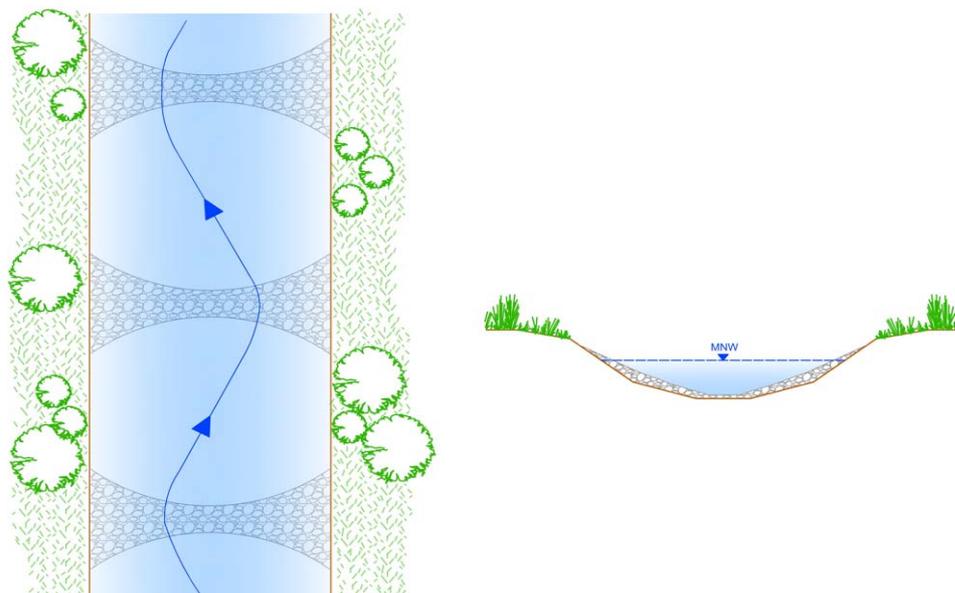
Prinzipskizze; Draufsicht (links) und Querschnitt Diagonale Grundschwelle (rechts)
